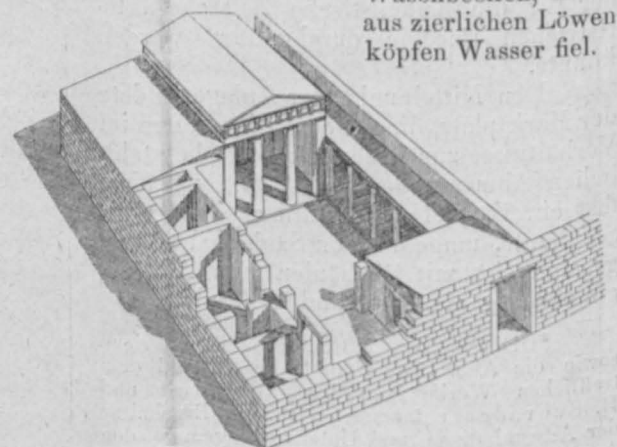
u. 21. Wohnhaus zu Priene. Grundriß und Rekonstruktion nach Th. Wiegand.
